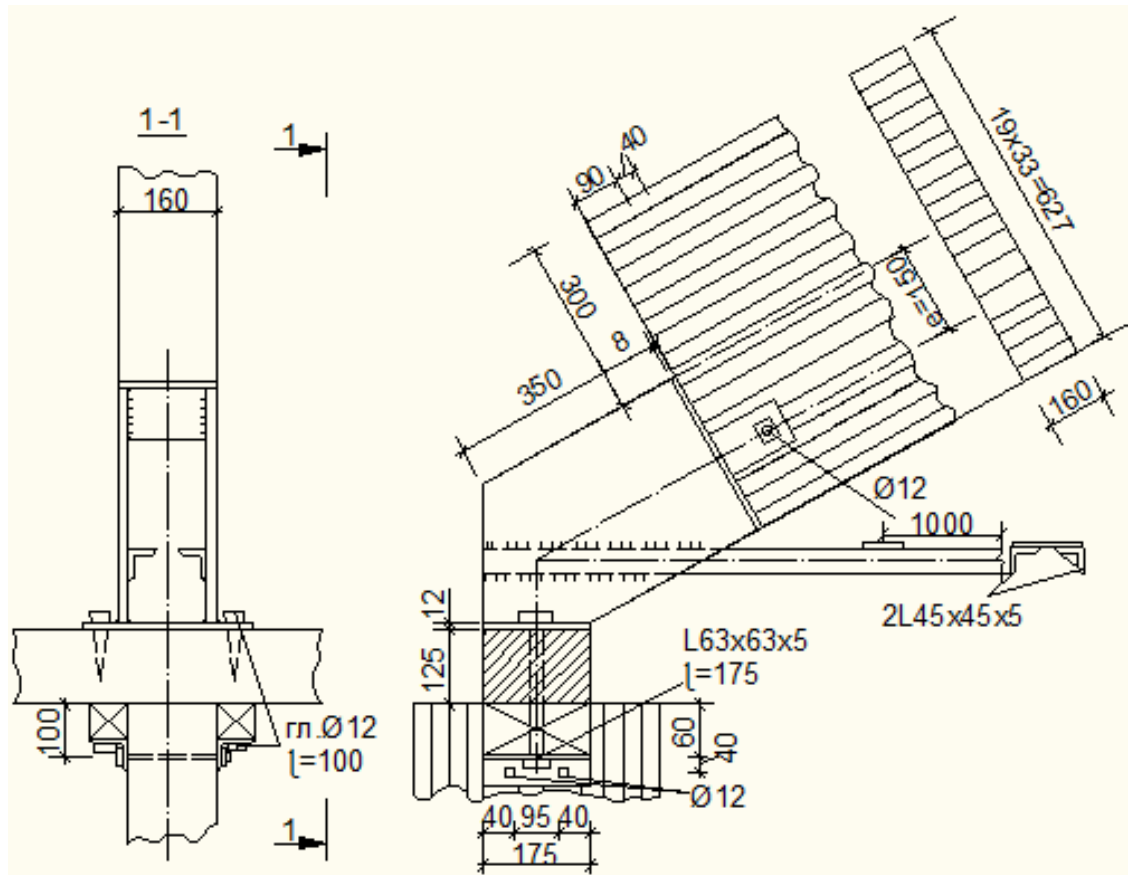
Конструкция опорного узла распорной системы треугольного очертания
